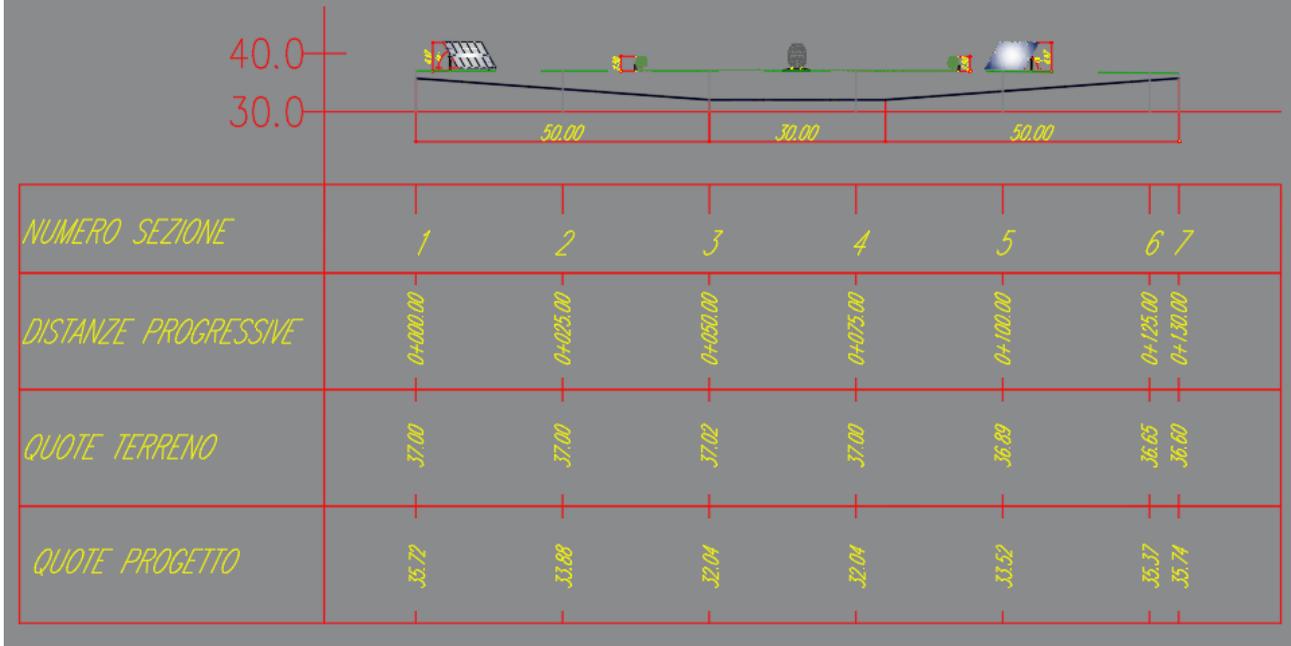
Sezione Attraversamento Rete Ferroviaria
